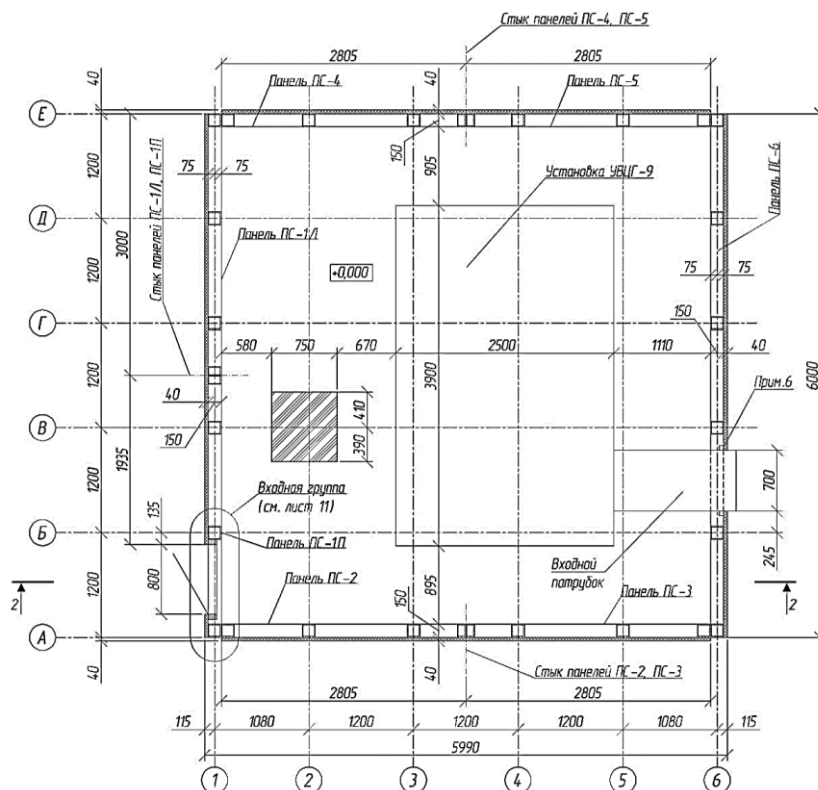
План мобильного укрытия вентиляционной установки УВЦГ-9
